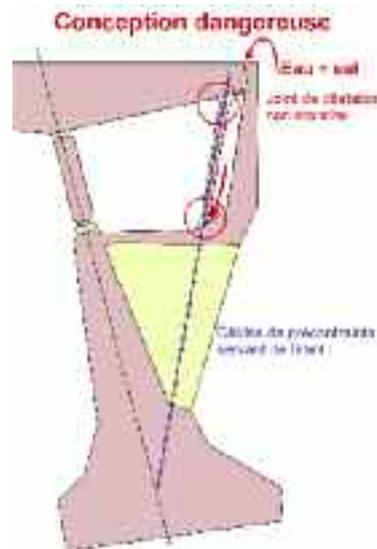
exemple de pont à béquilles potentiellement fragile qui s'est effondré brutalement lors du passage d'un camion
